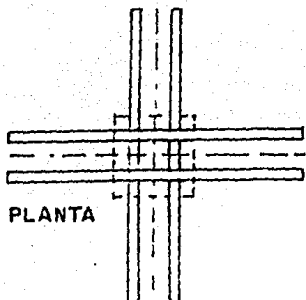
Modos de falla por cortante en la conexión losa plana-columna
